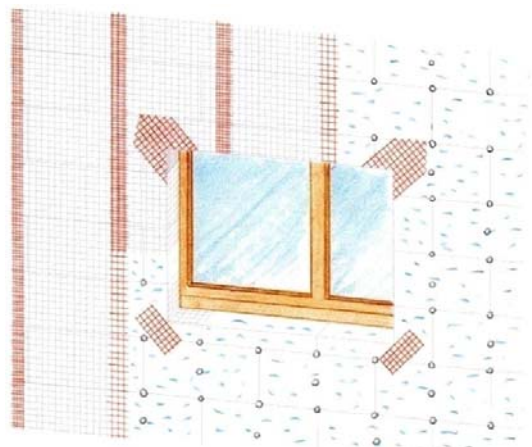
Detalle de aplicación de malla de armadura en el ángulo de esquinas de ventanas y puertas
